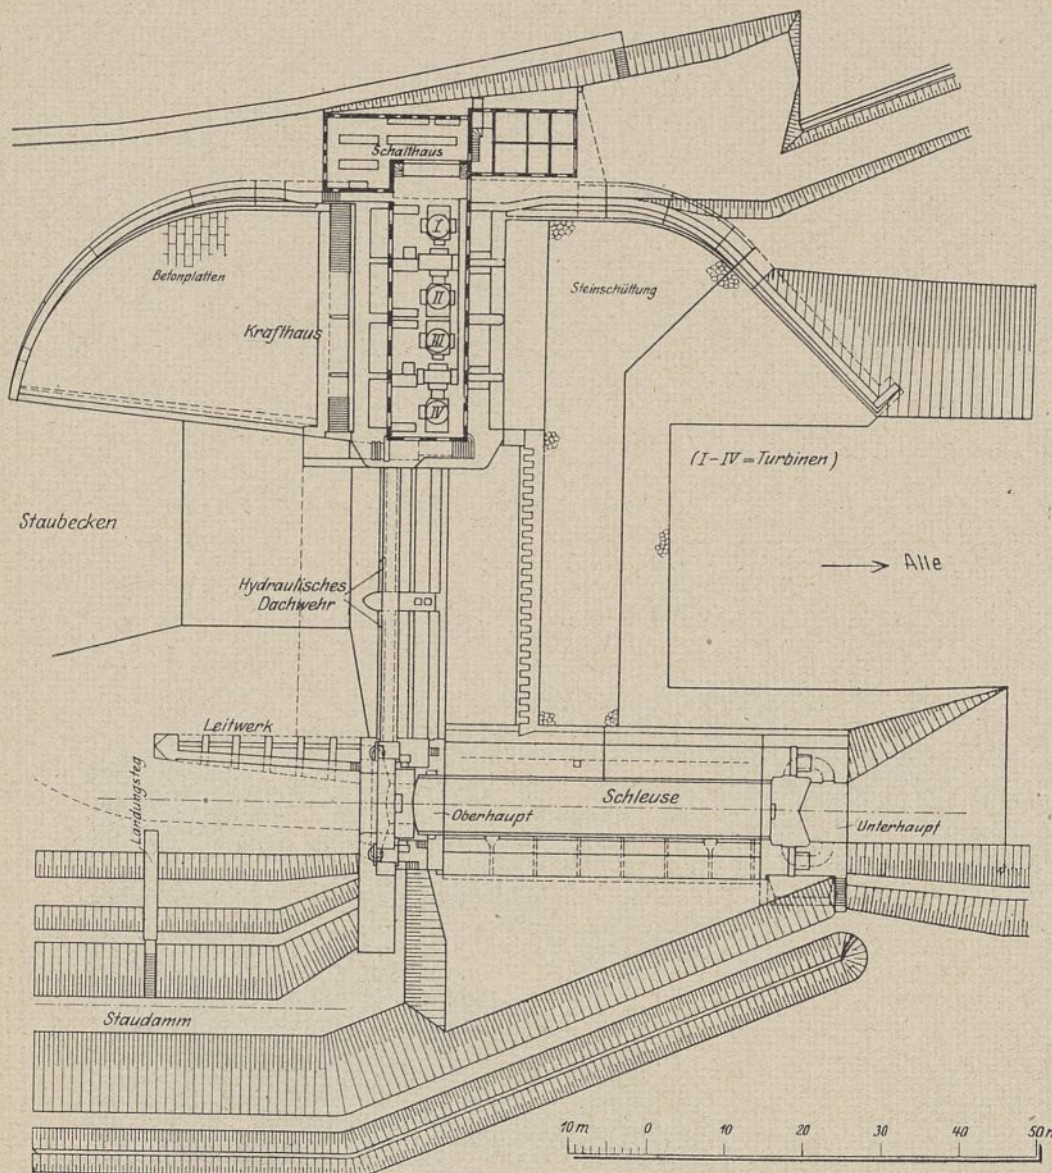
Kraftwerk bei Groß-Wohnsdorff, Grundriß der Anlage.
